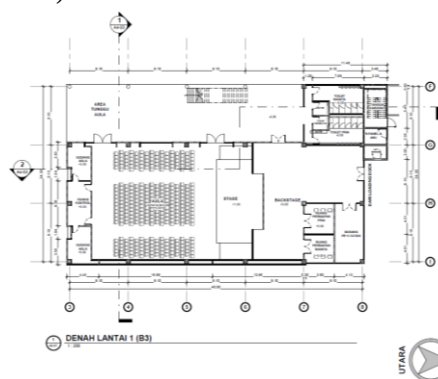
Layout Lantai 1 (Massa Bangunan 2)
